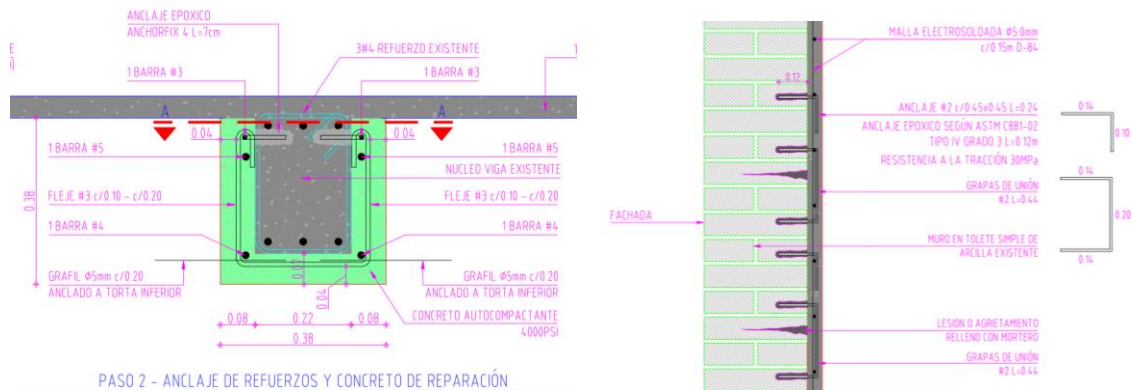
Propuesta de intervención reforzamiento vigas y muros de fachada.
